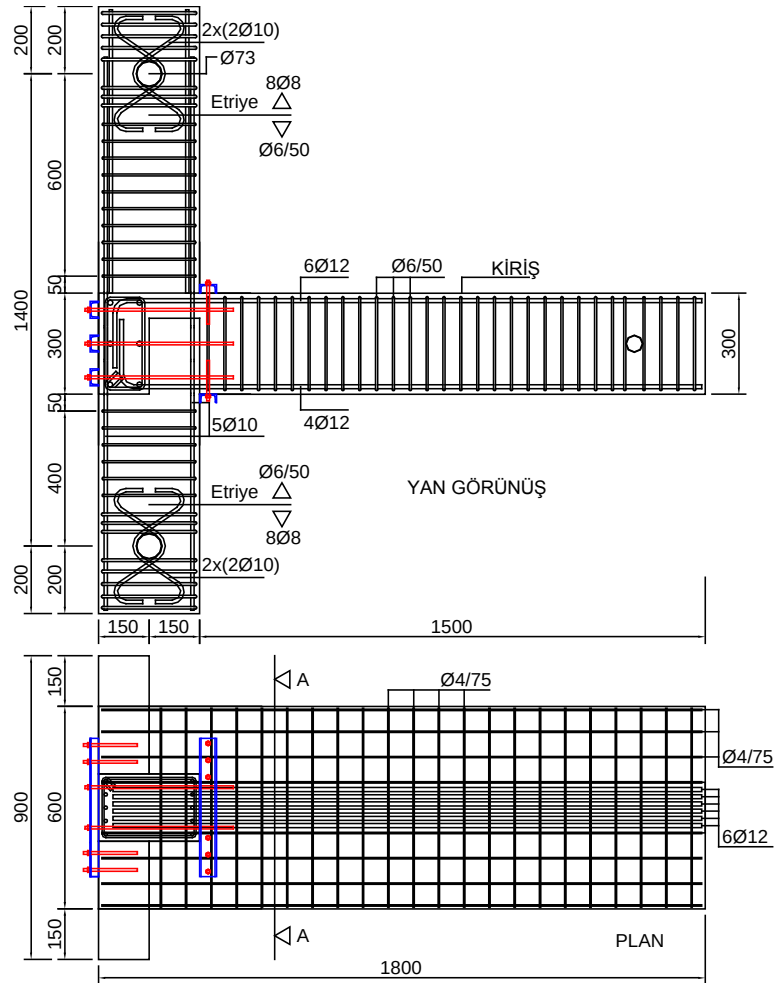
WC2d elemanı donatı detay çizimleri
